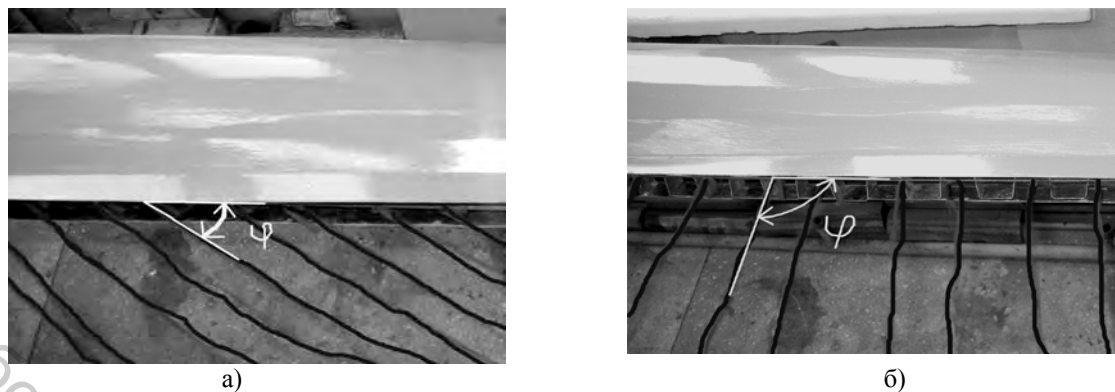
Выход воздуха из воздухораспределителя (вид сверху): а – при свободном истечении из продольной щели; б – через направляющие решетки
